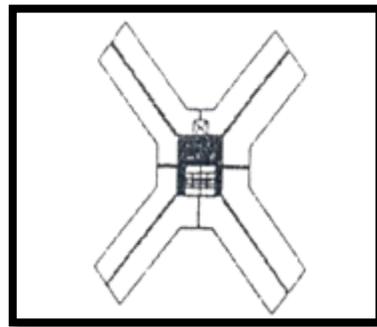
Bentuk Denah *Expanded Tower Plan
